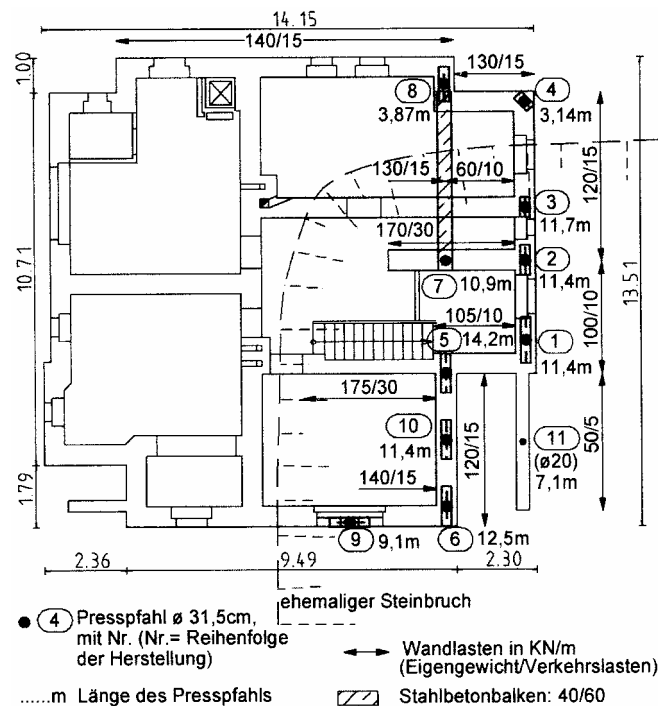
Grundriss mit Anordnung der Segmentpfähle, System Erka
